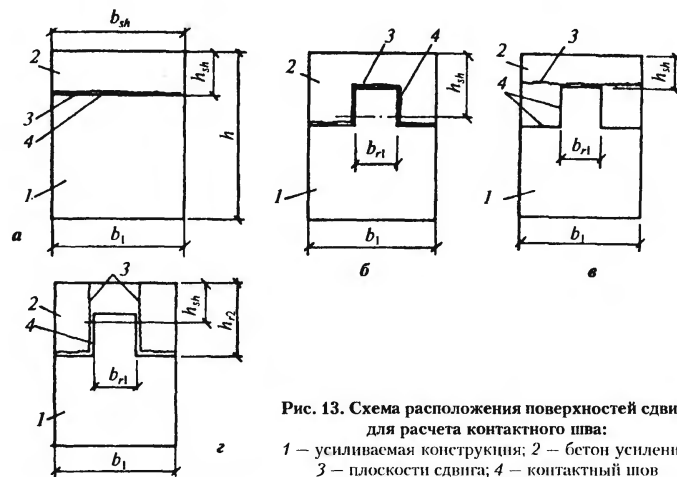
Схема расположения поверхностей сдвига для расчета контактного шва:
